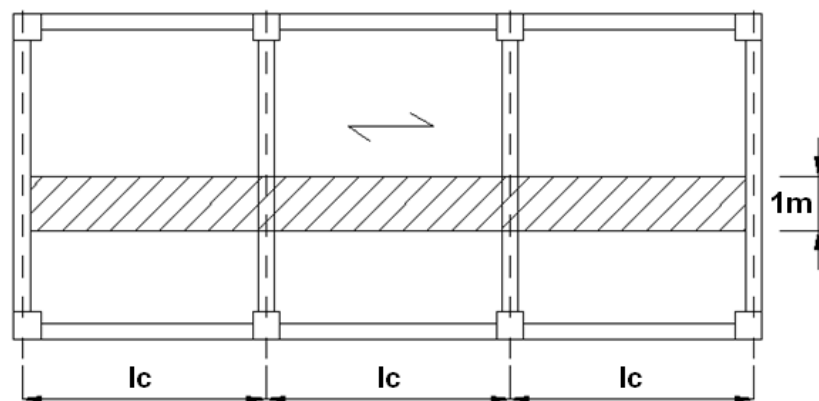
Franja de 1m de ancho de losa en una dirección.
